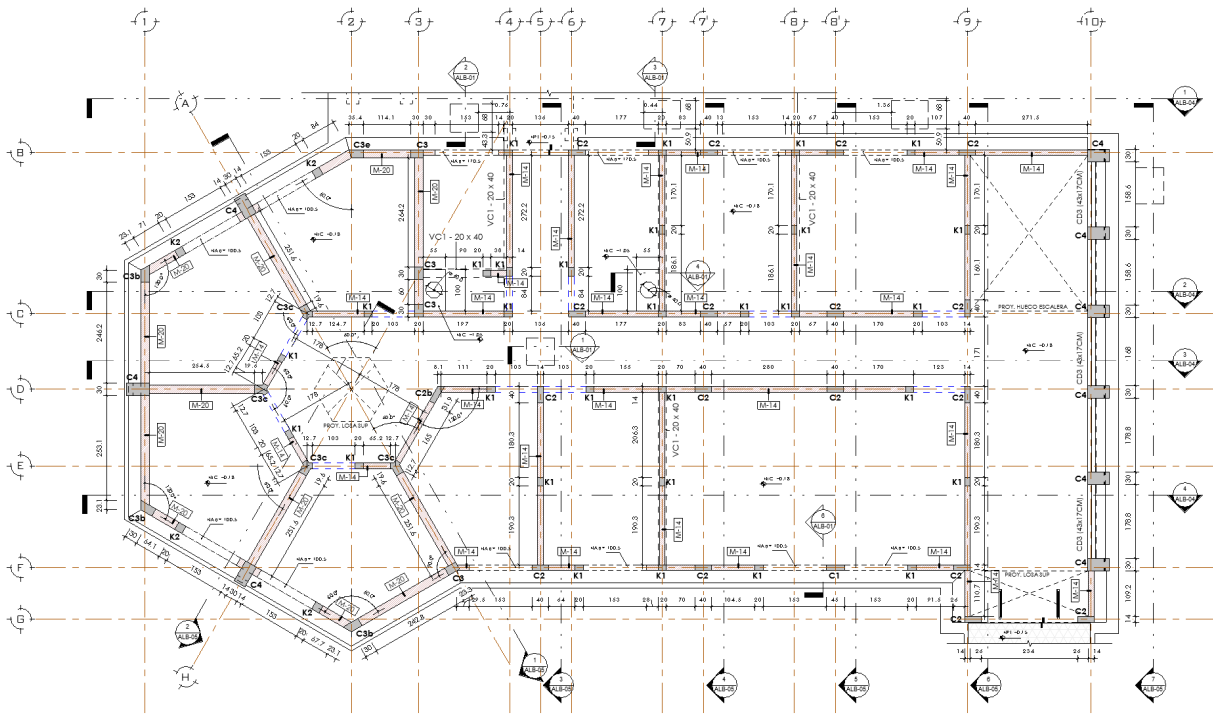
Ejemplo de plano de albañilería (ver plano ALB-01).
